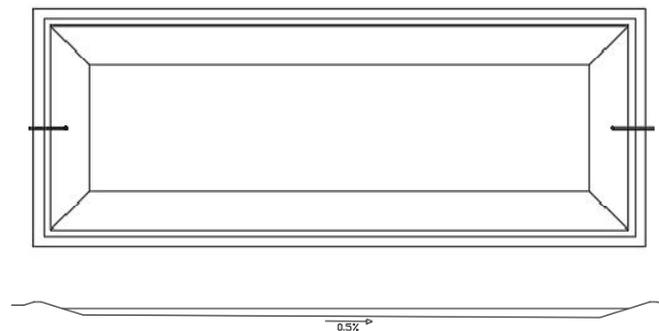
Detalle planta y alzado de laguna facultativa. Fuente: Edición propia
